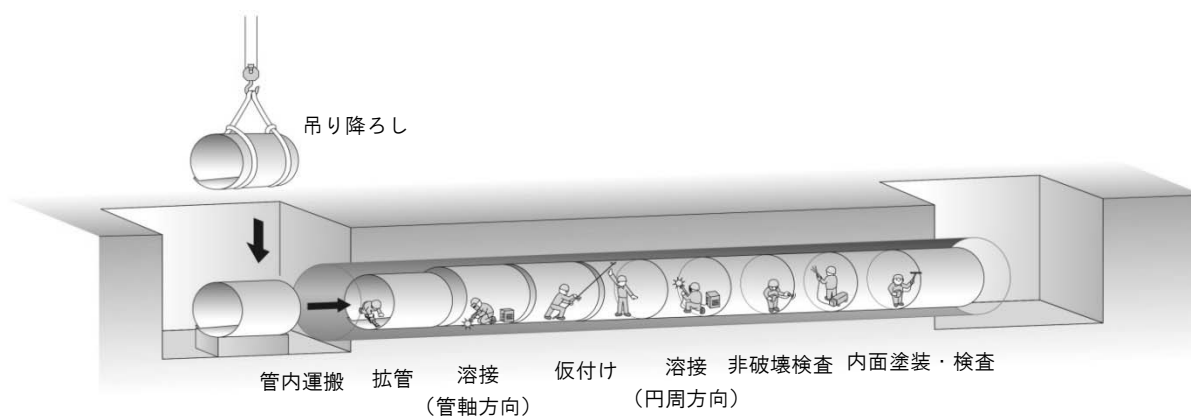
鞘管工法施工概要（巻き込み・溶接）（鋼管例）
